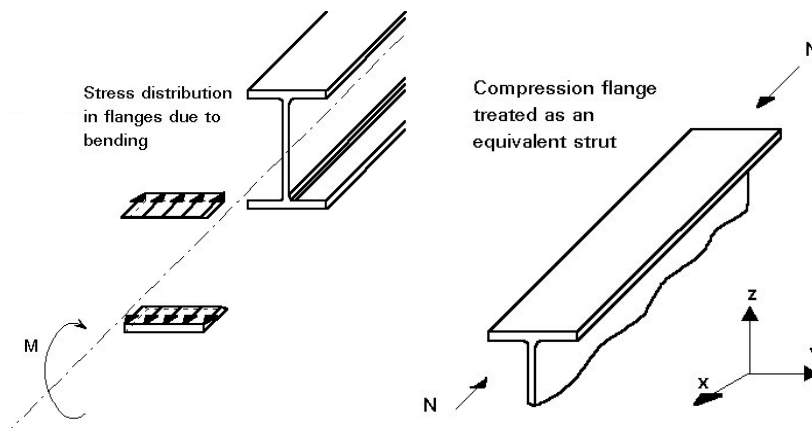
Approximation entre flambement d'un poteau et déversement d'une poutre.
